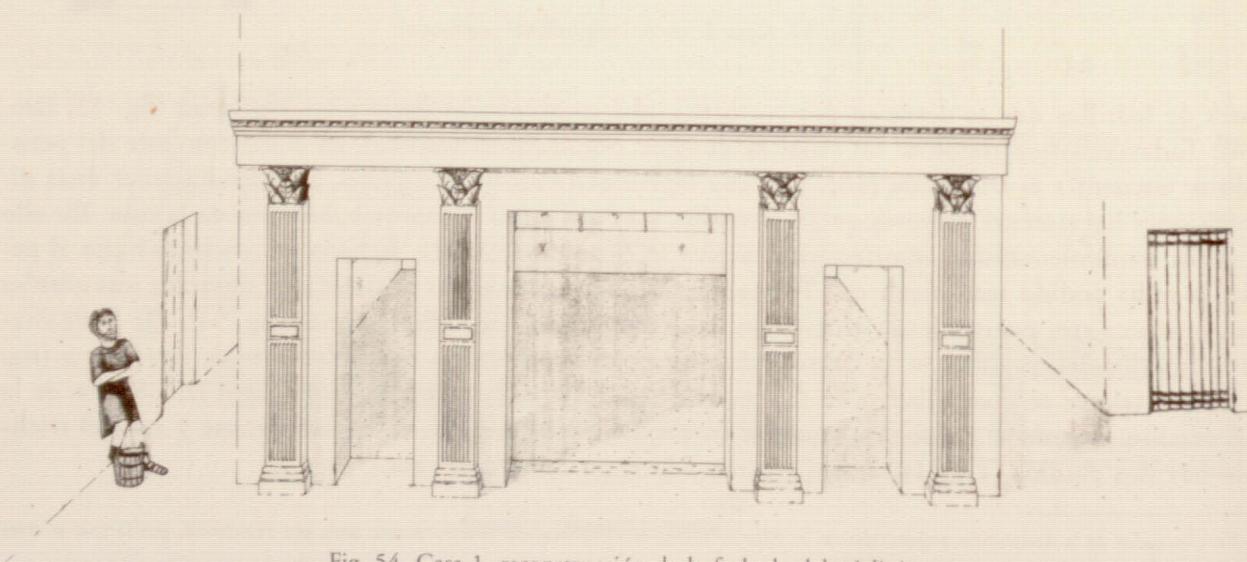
Casa 1, reconstrucción de la fachada del triclinio.
